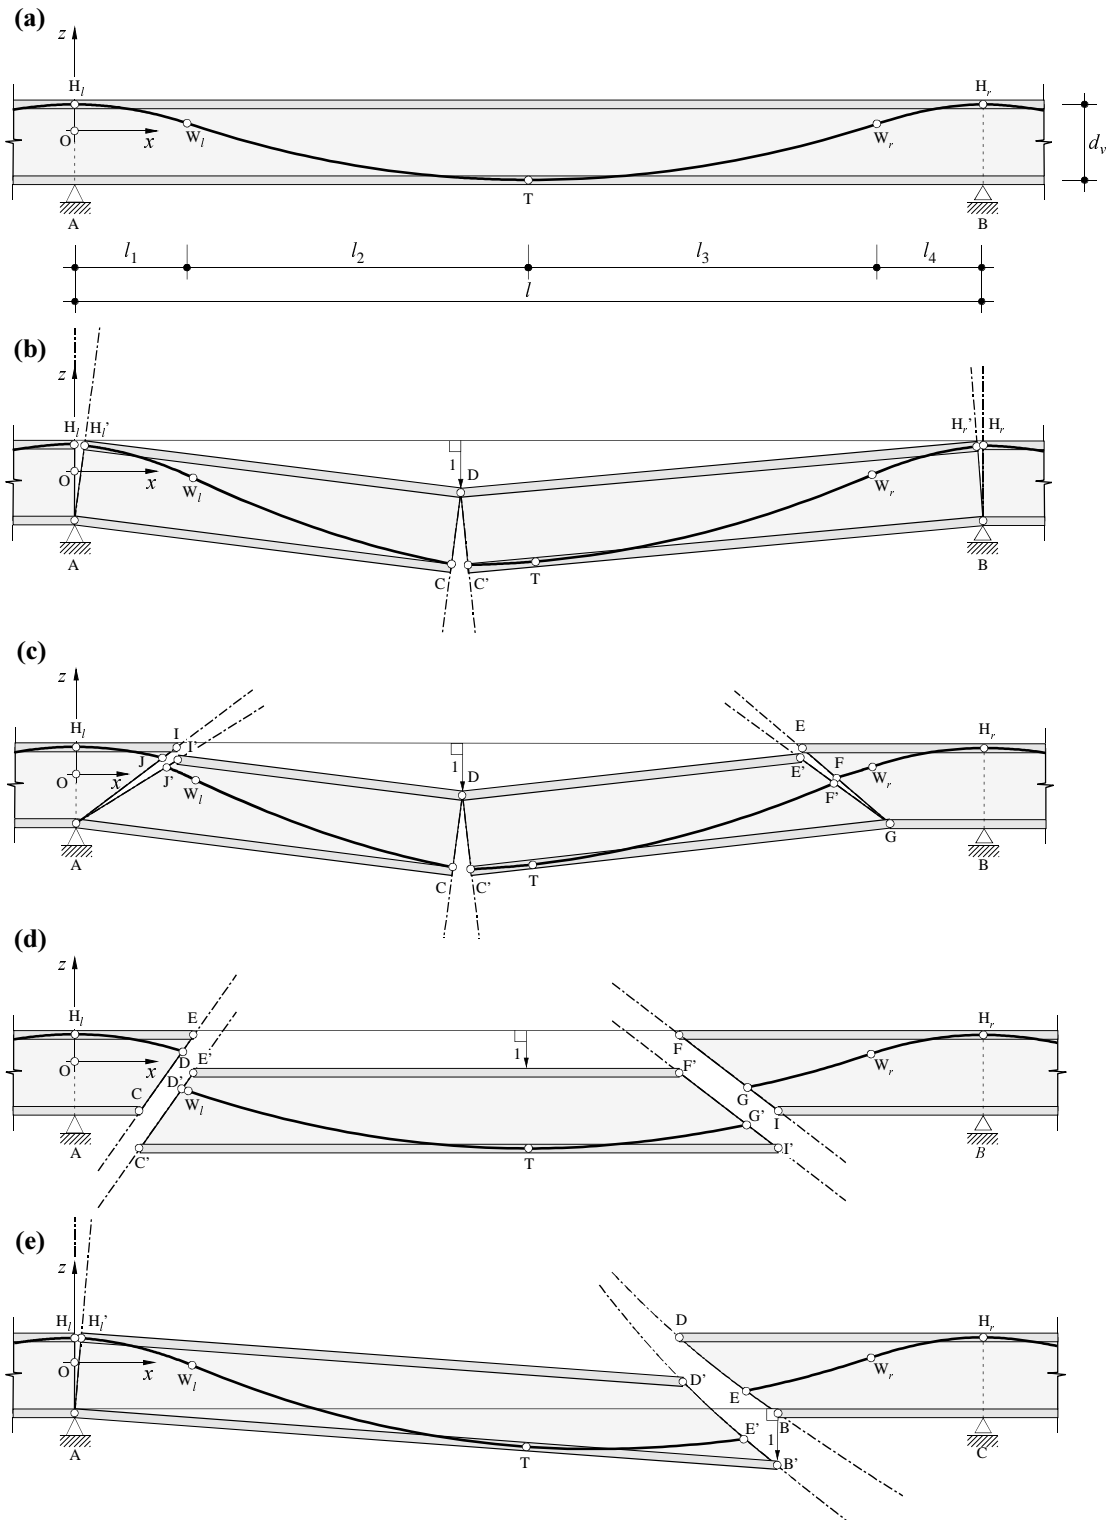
Bruchmechanismen für Randfeldträger: (a) Geometrie; (b) Biegemechanismus; (c) kombinierter Biege-Biegeschubbruchmechanismus; (d) Stegdruckbruchmechanismus.
